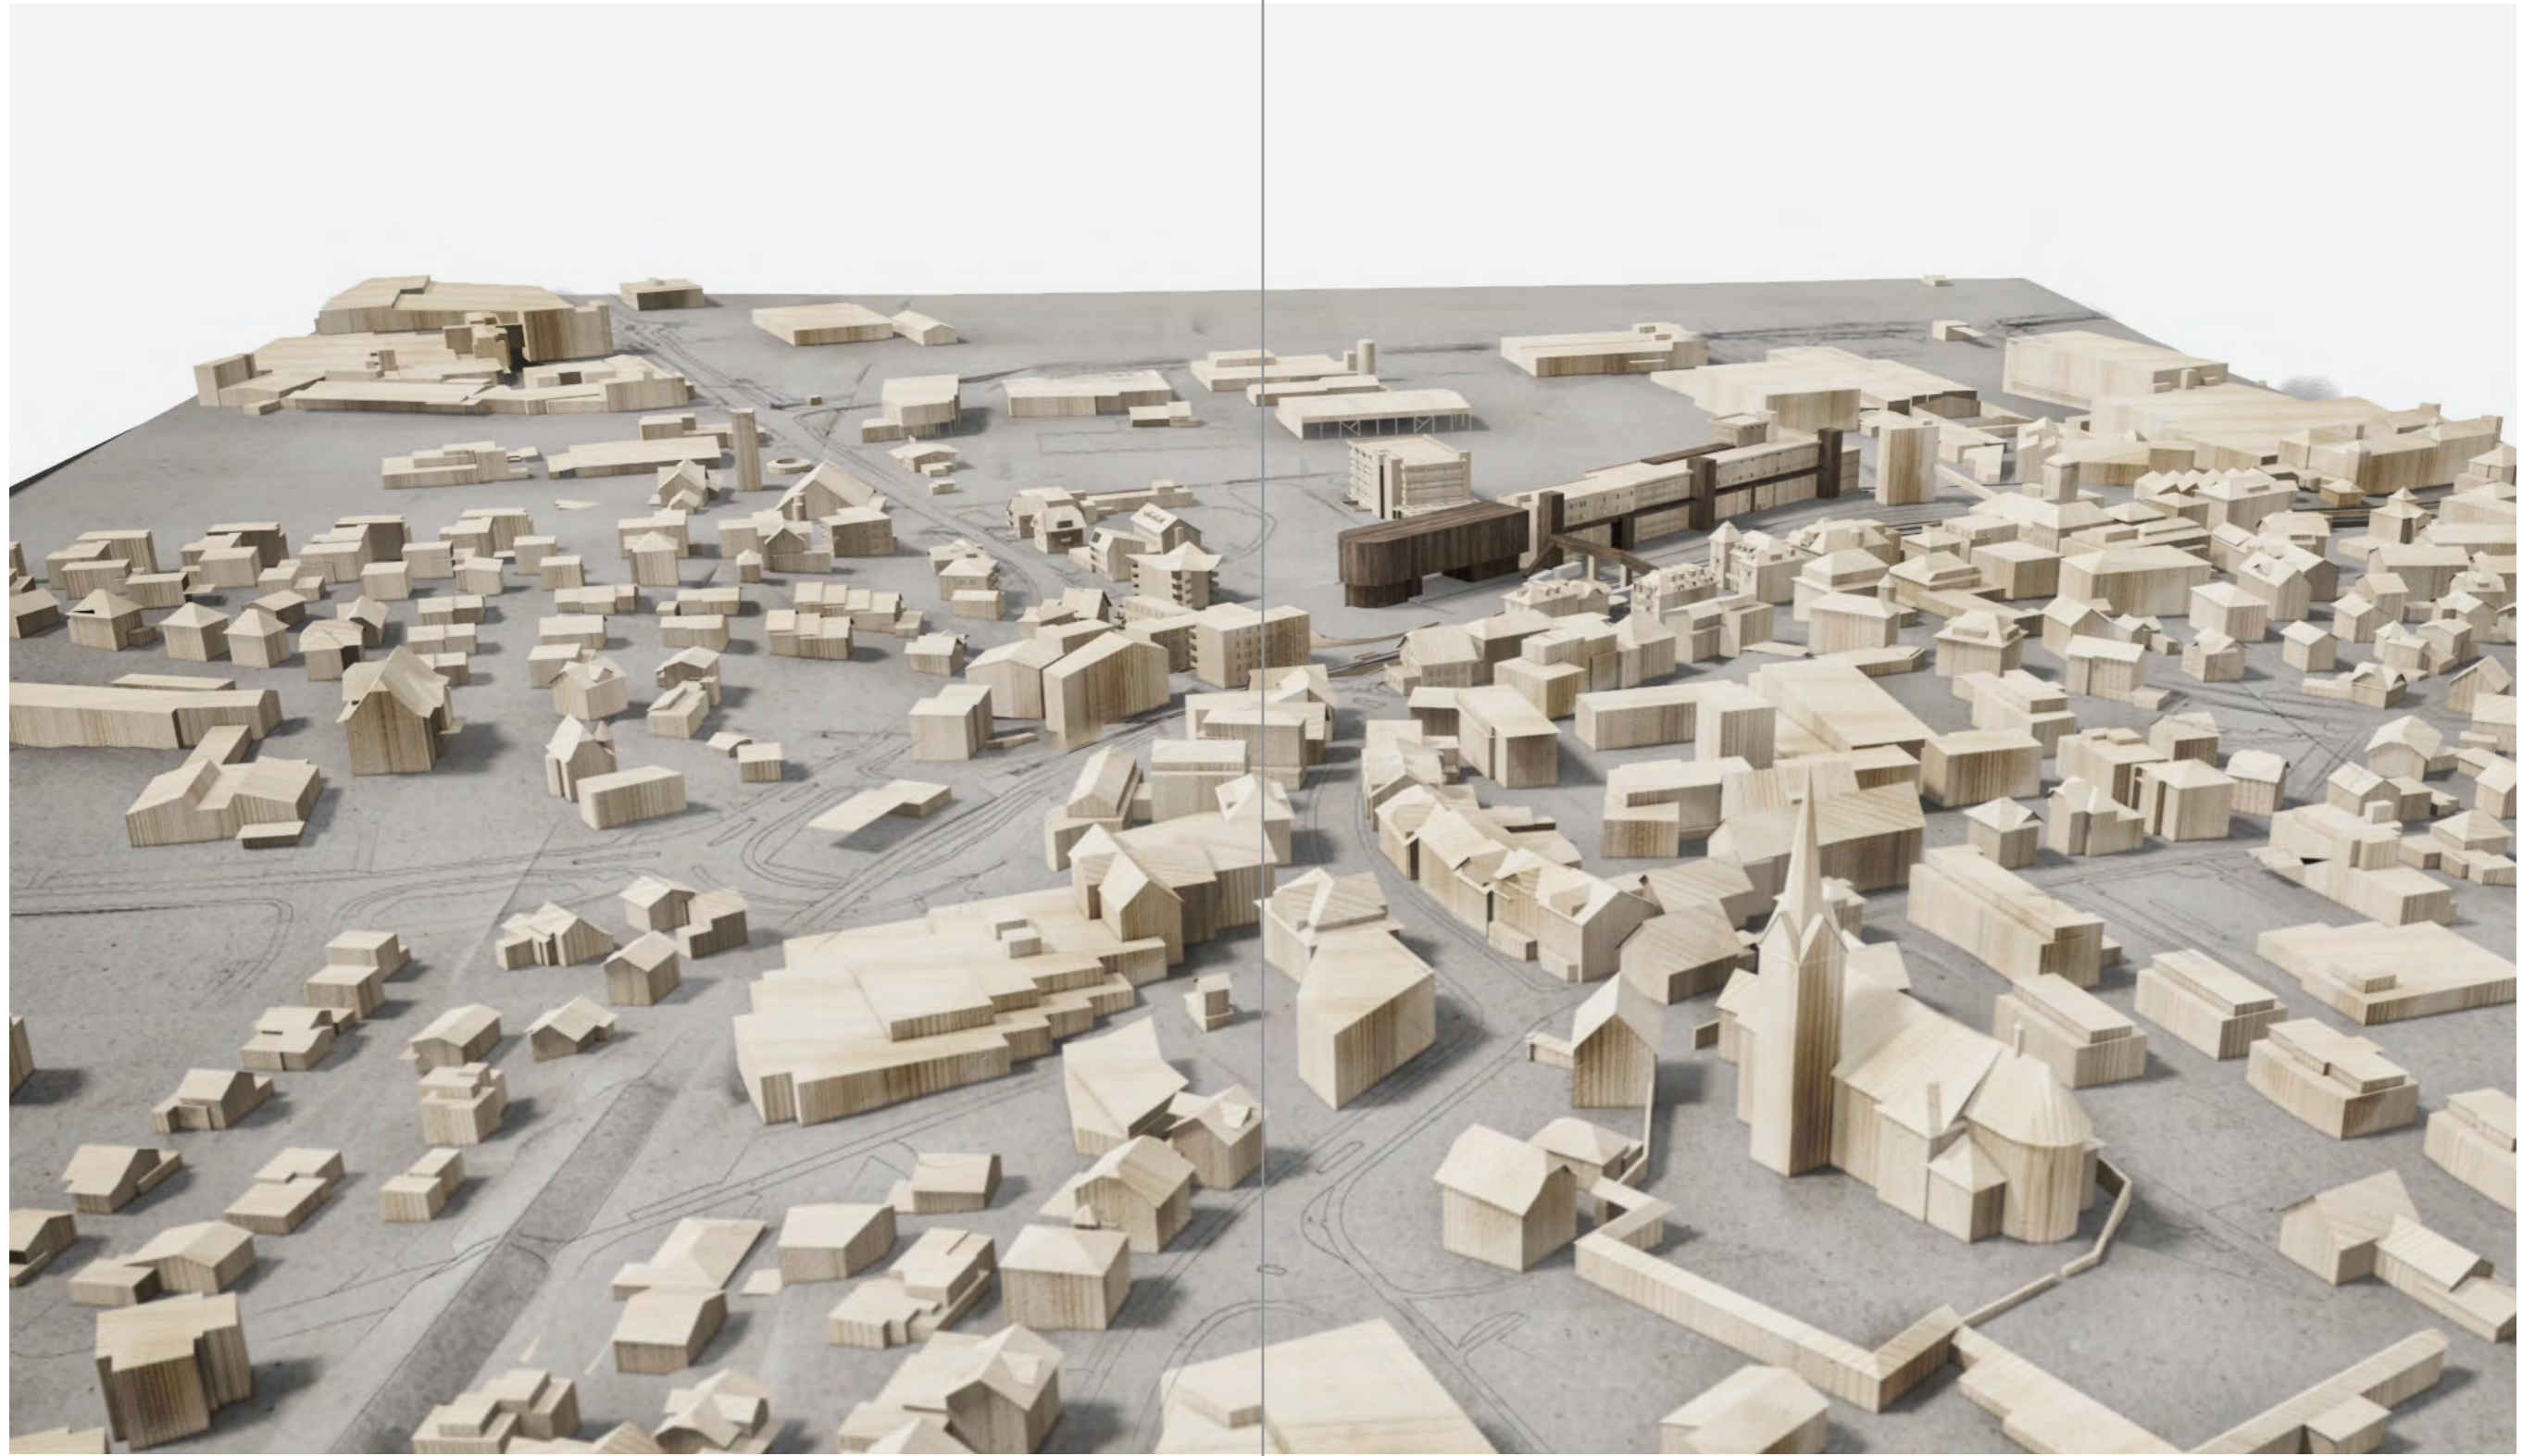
Städtebauliches Modell, Blick Richtung Westen
